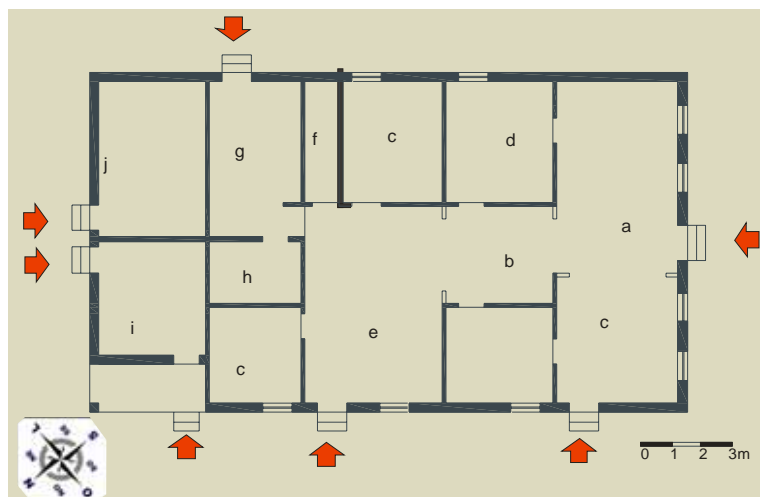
Planta baixa da casa da propriedade da Fabriqueta 3
